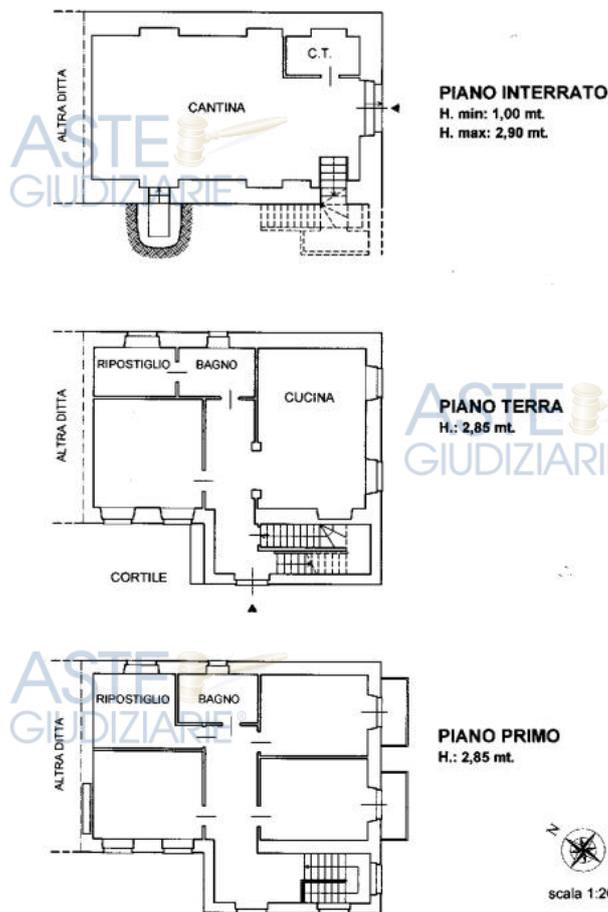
Estratto planimetria catastale AT0076437 del 17.05.2012
